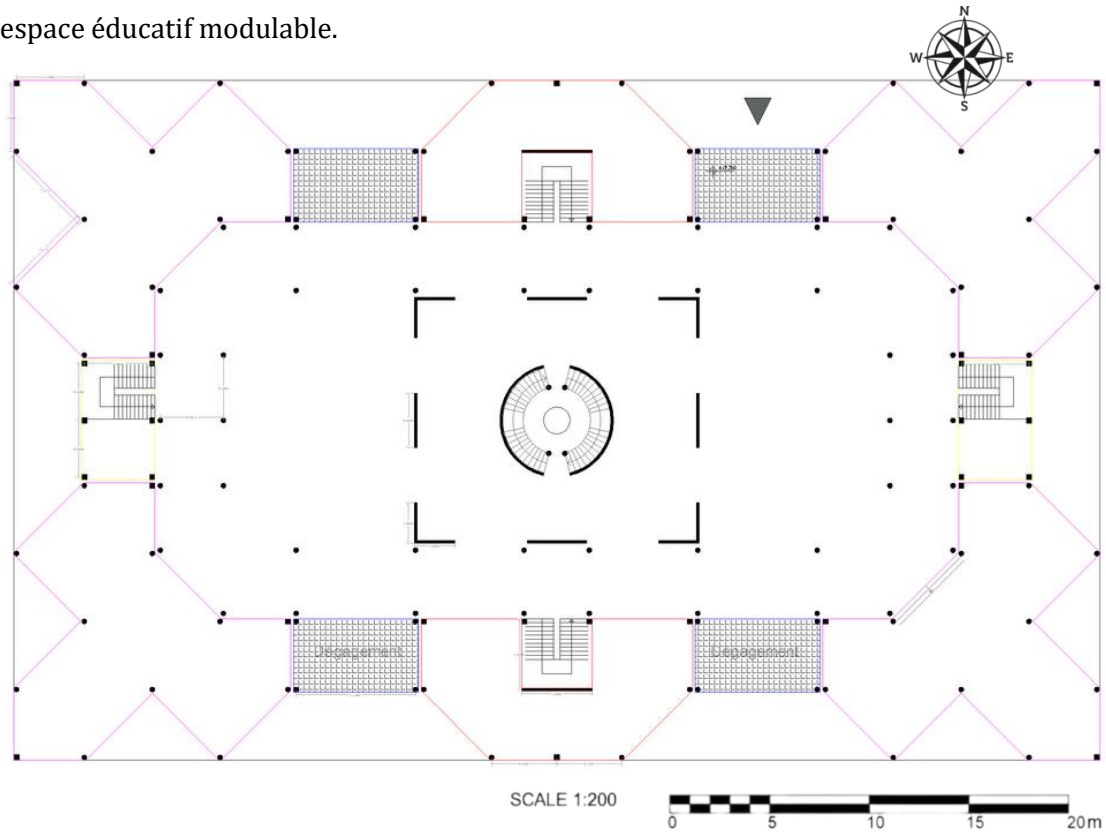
PLAN DE STRUCTURE D'ENTITÉ PÉDAGOGIQUE; SOURCE: AUTEUR
